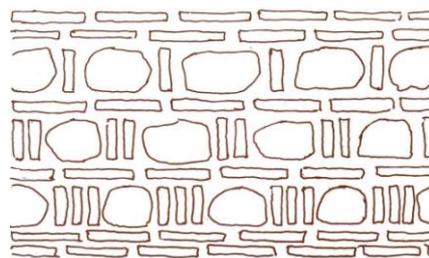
Mampostería tipo *opus cloisonné*, primera fase de construcción, época de Zar Samuel, 1000-1014.
